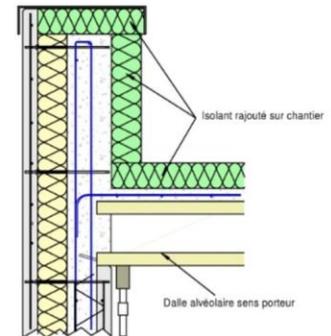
Plancher suspendu avec attentes posées sur chantier
